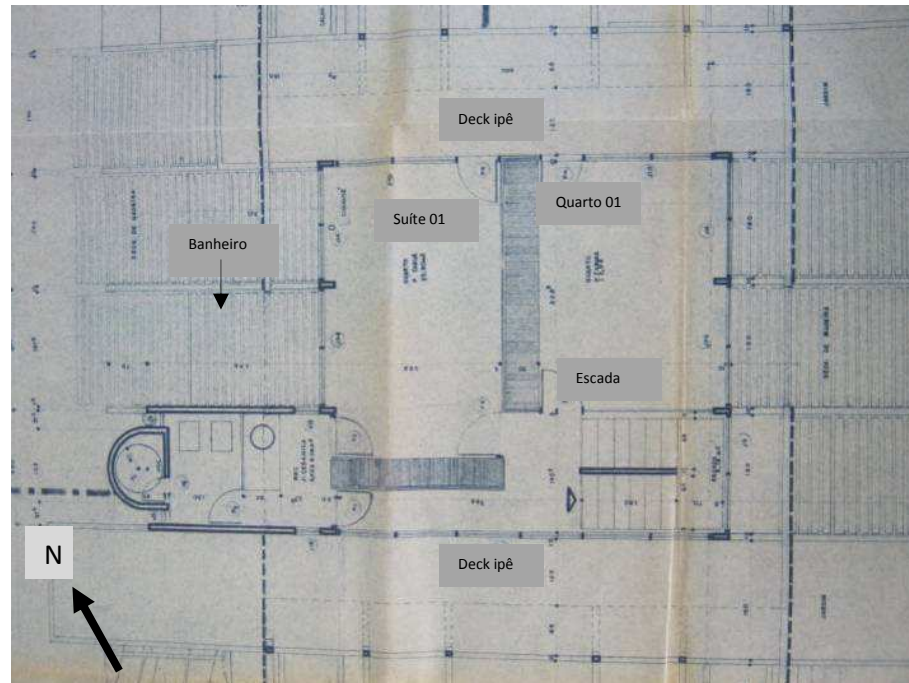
Residência Othello Lopes Filho*: Planta do segundo pavimento
